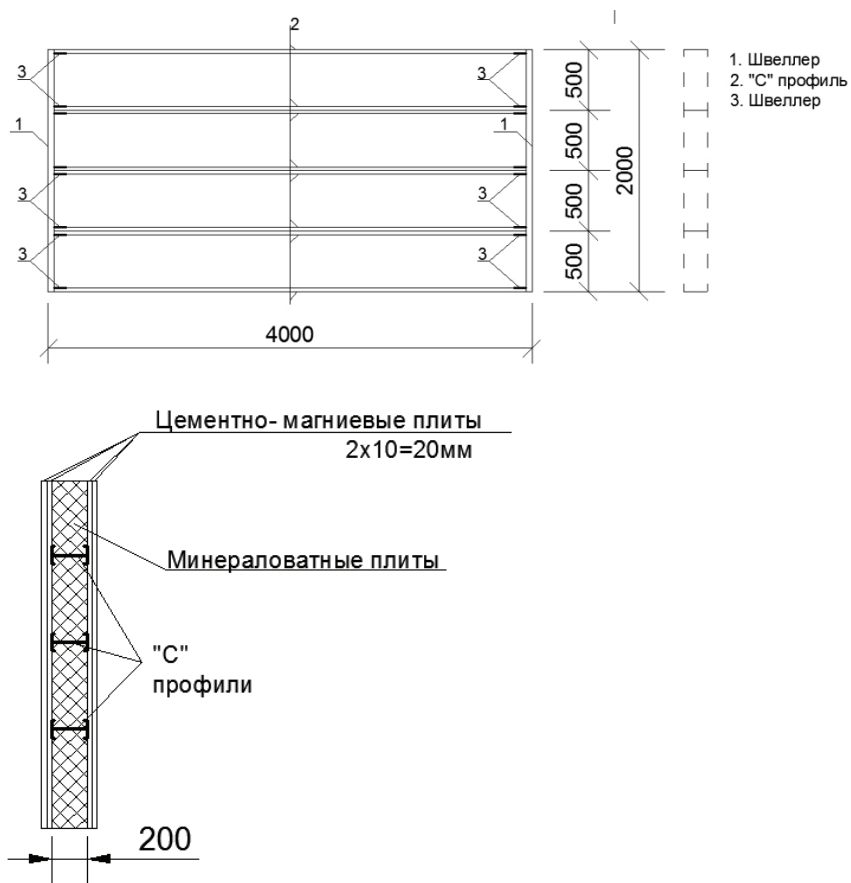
Эскиз конструкции опытного образца фрагмента междуэтажного перекрытия
